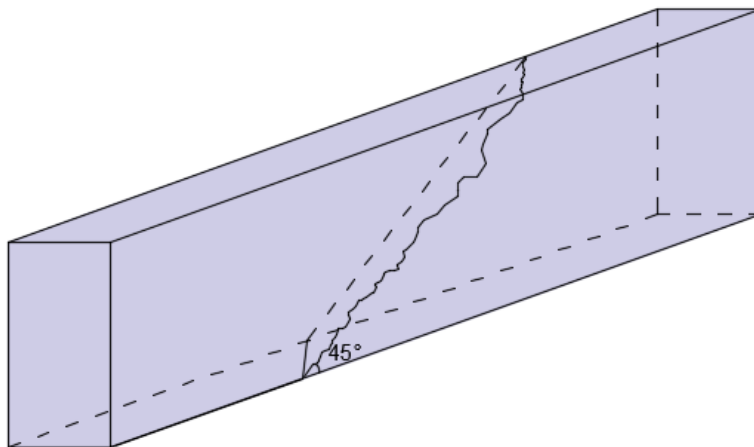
Superficie de falla de un elemento de concreto simple sometido a tensión
